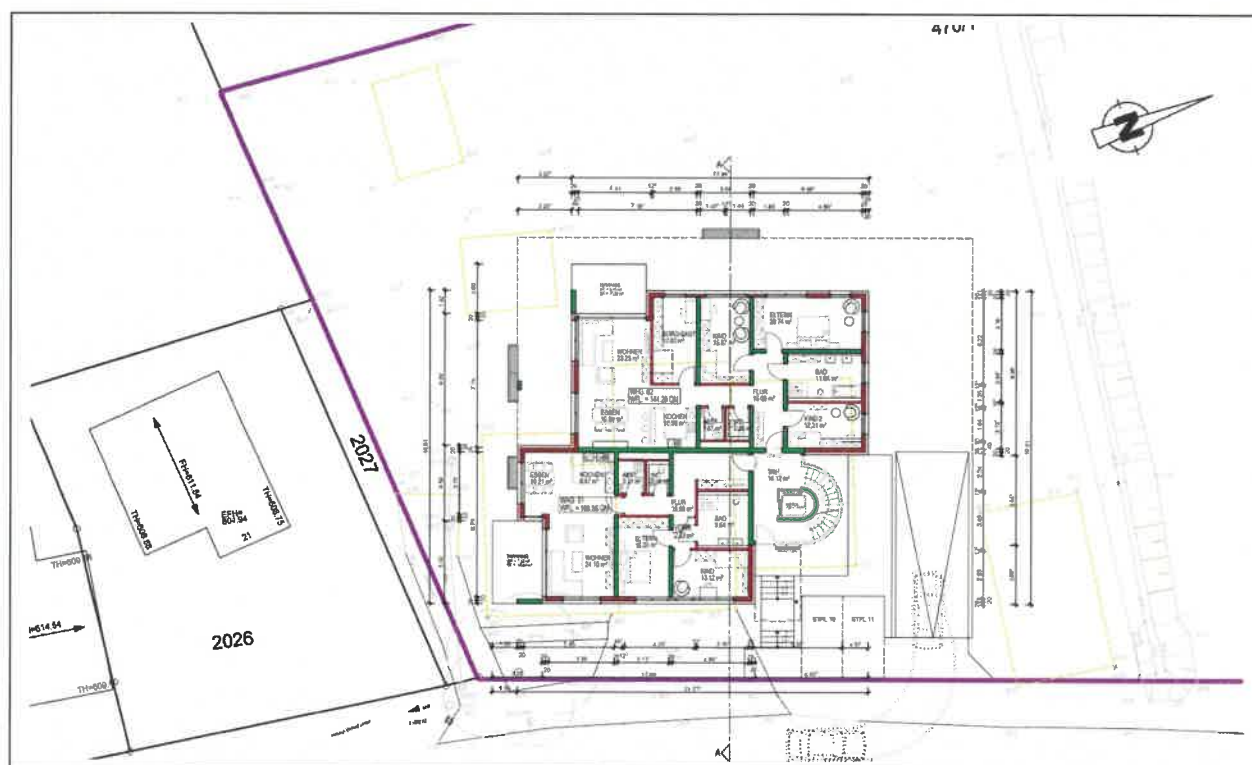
Planung des BV auf Flurstück 470/1. Ausschnitt aus dem Plan „Grundriss Erdgeschoss“ (schairer+partner architekten, Stand 14.06.2019). Als gelbe Konturen sind die Bestandsgebäude hinterlegt. Norden ist rechts oben.
